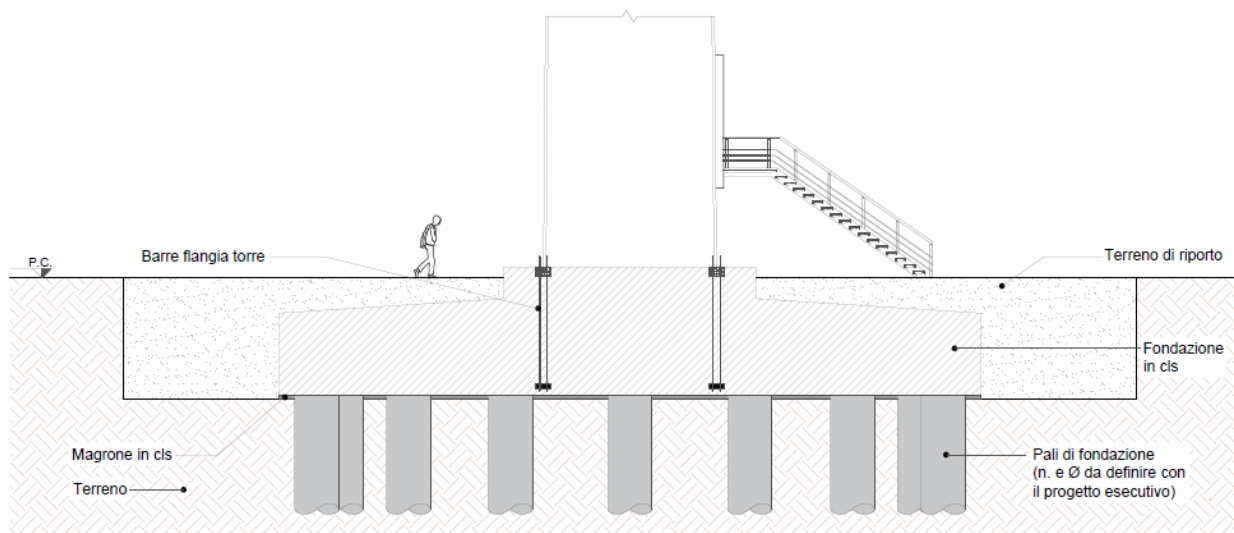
Sezione tipo aerogeneratore - piastra di fondazione su pali
